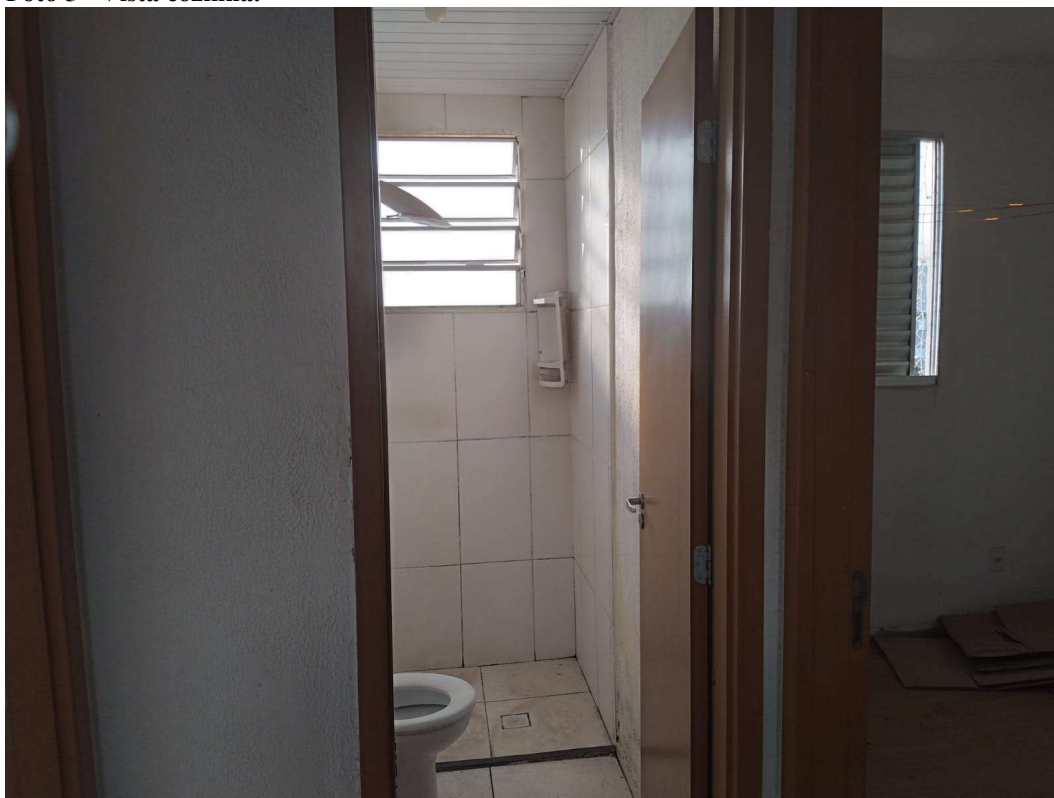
Vista banheiro. Azulejo até o teto apenas na área do box.
